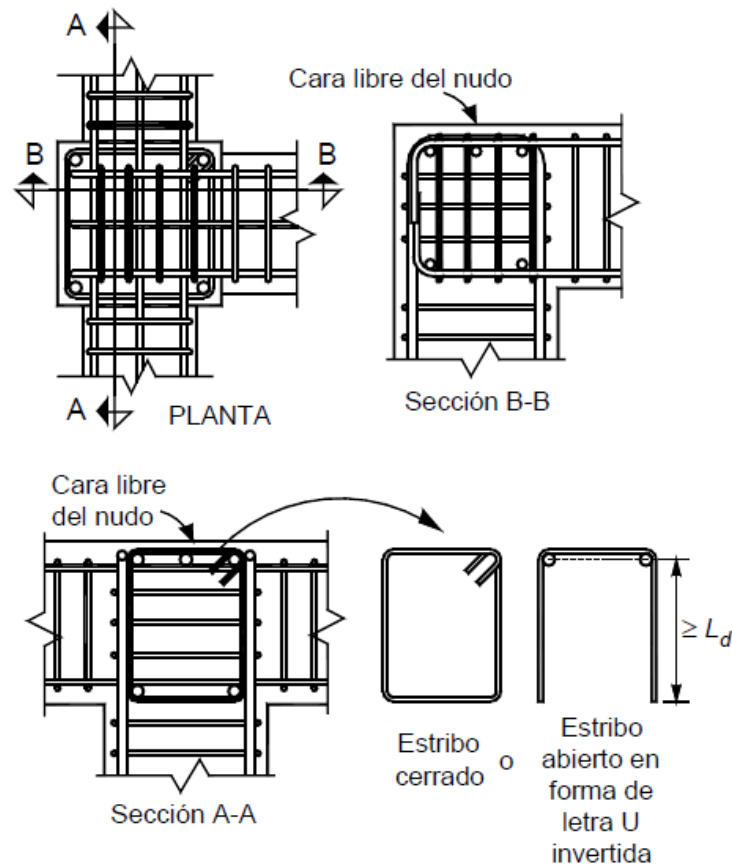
Refuerzo transversal vertical en uniones viga-columna (NTCC, 2004).
